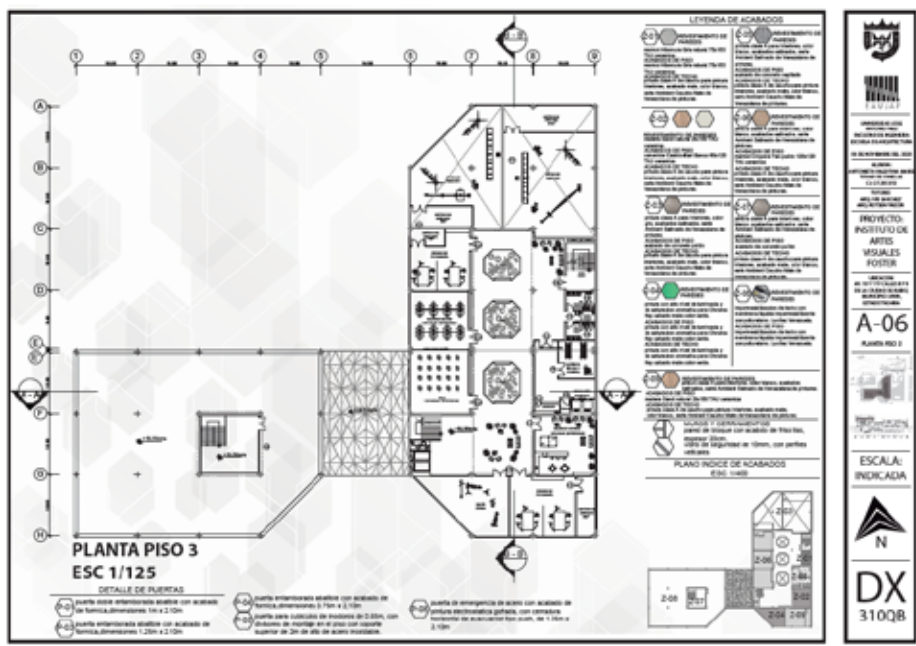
Plano de Planta Nivel 3. La autora (2020)
